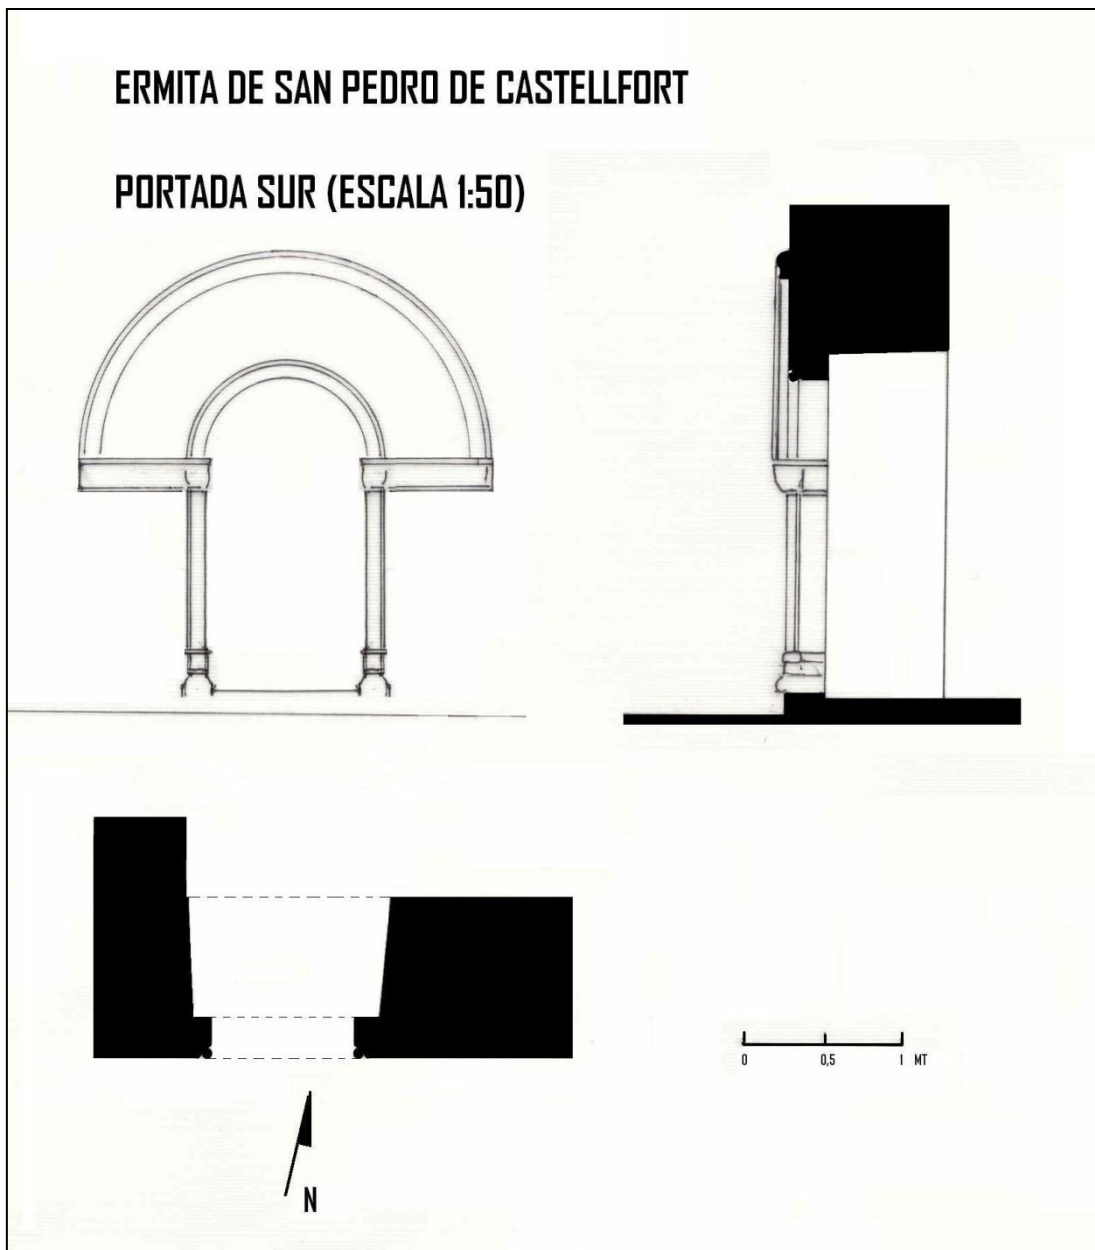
Diseño en alzado, planta y perfil de la portada sur (Francisco J. Soriano).
